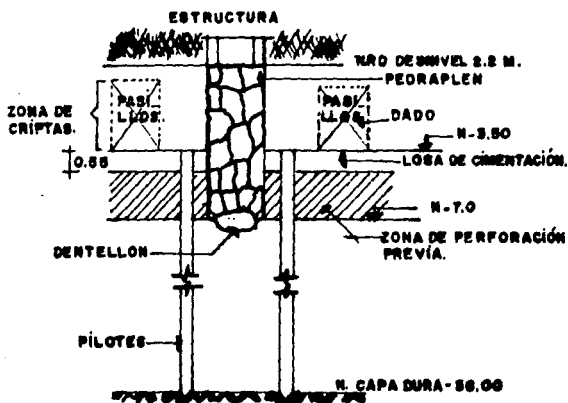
LOSAS DE CIMENTACIÓN.
